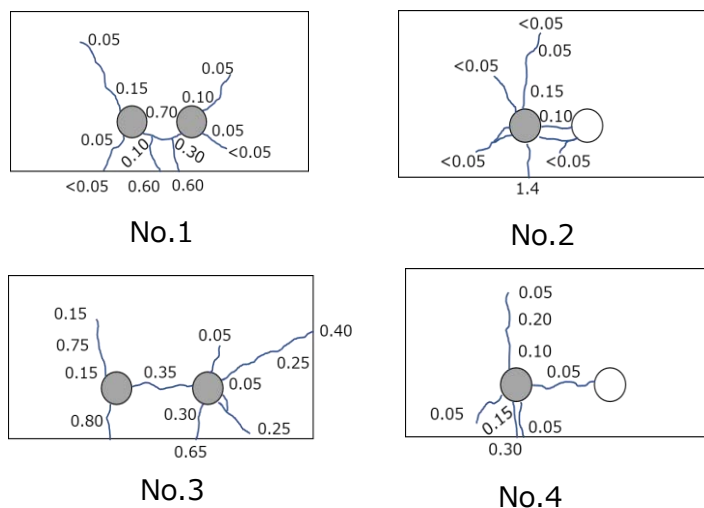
切断面におけるひび割れ図（図中単位 mm）
